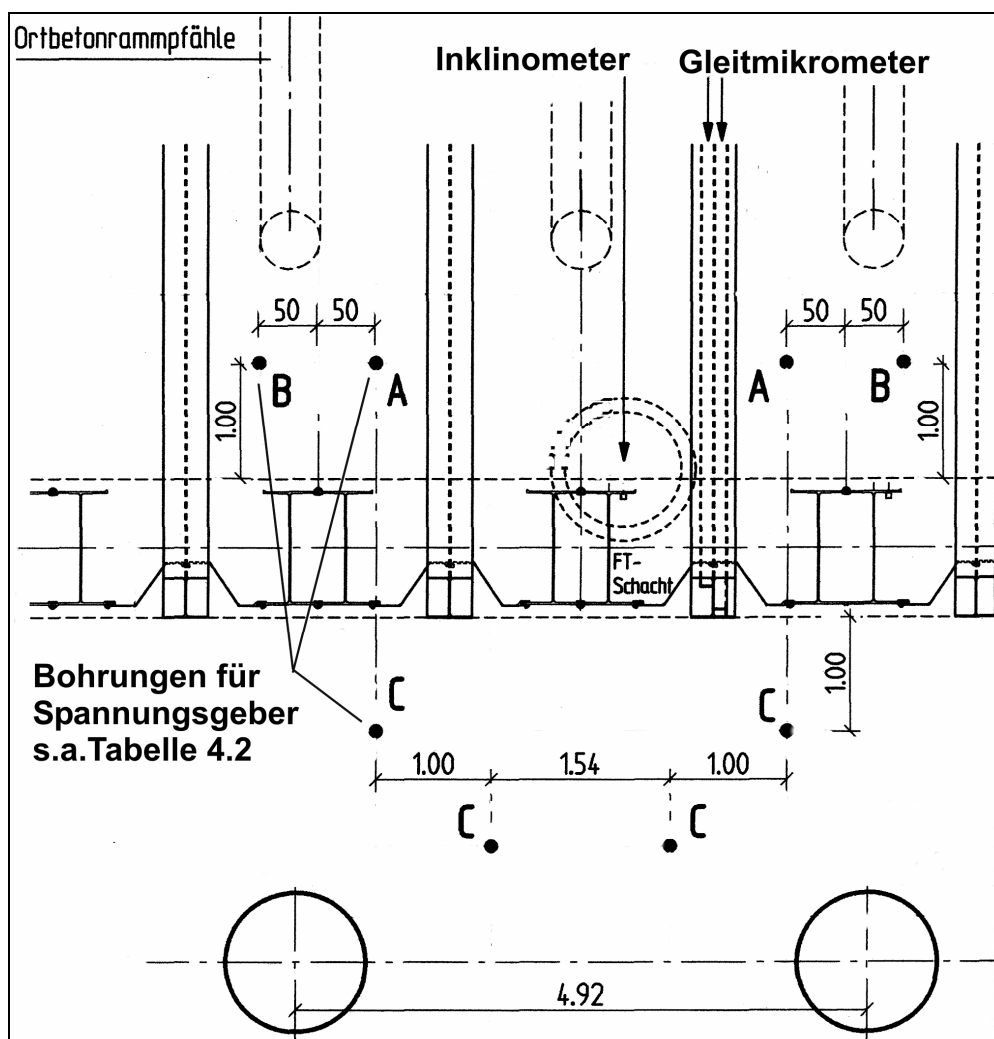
Lageplan der Bohrungen für EDK und PWD im Grundriss
